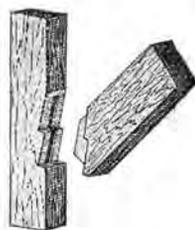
Assemblage oblique à tenon à deux abouts.
